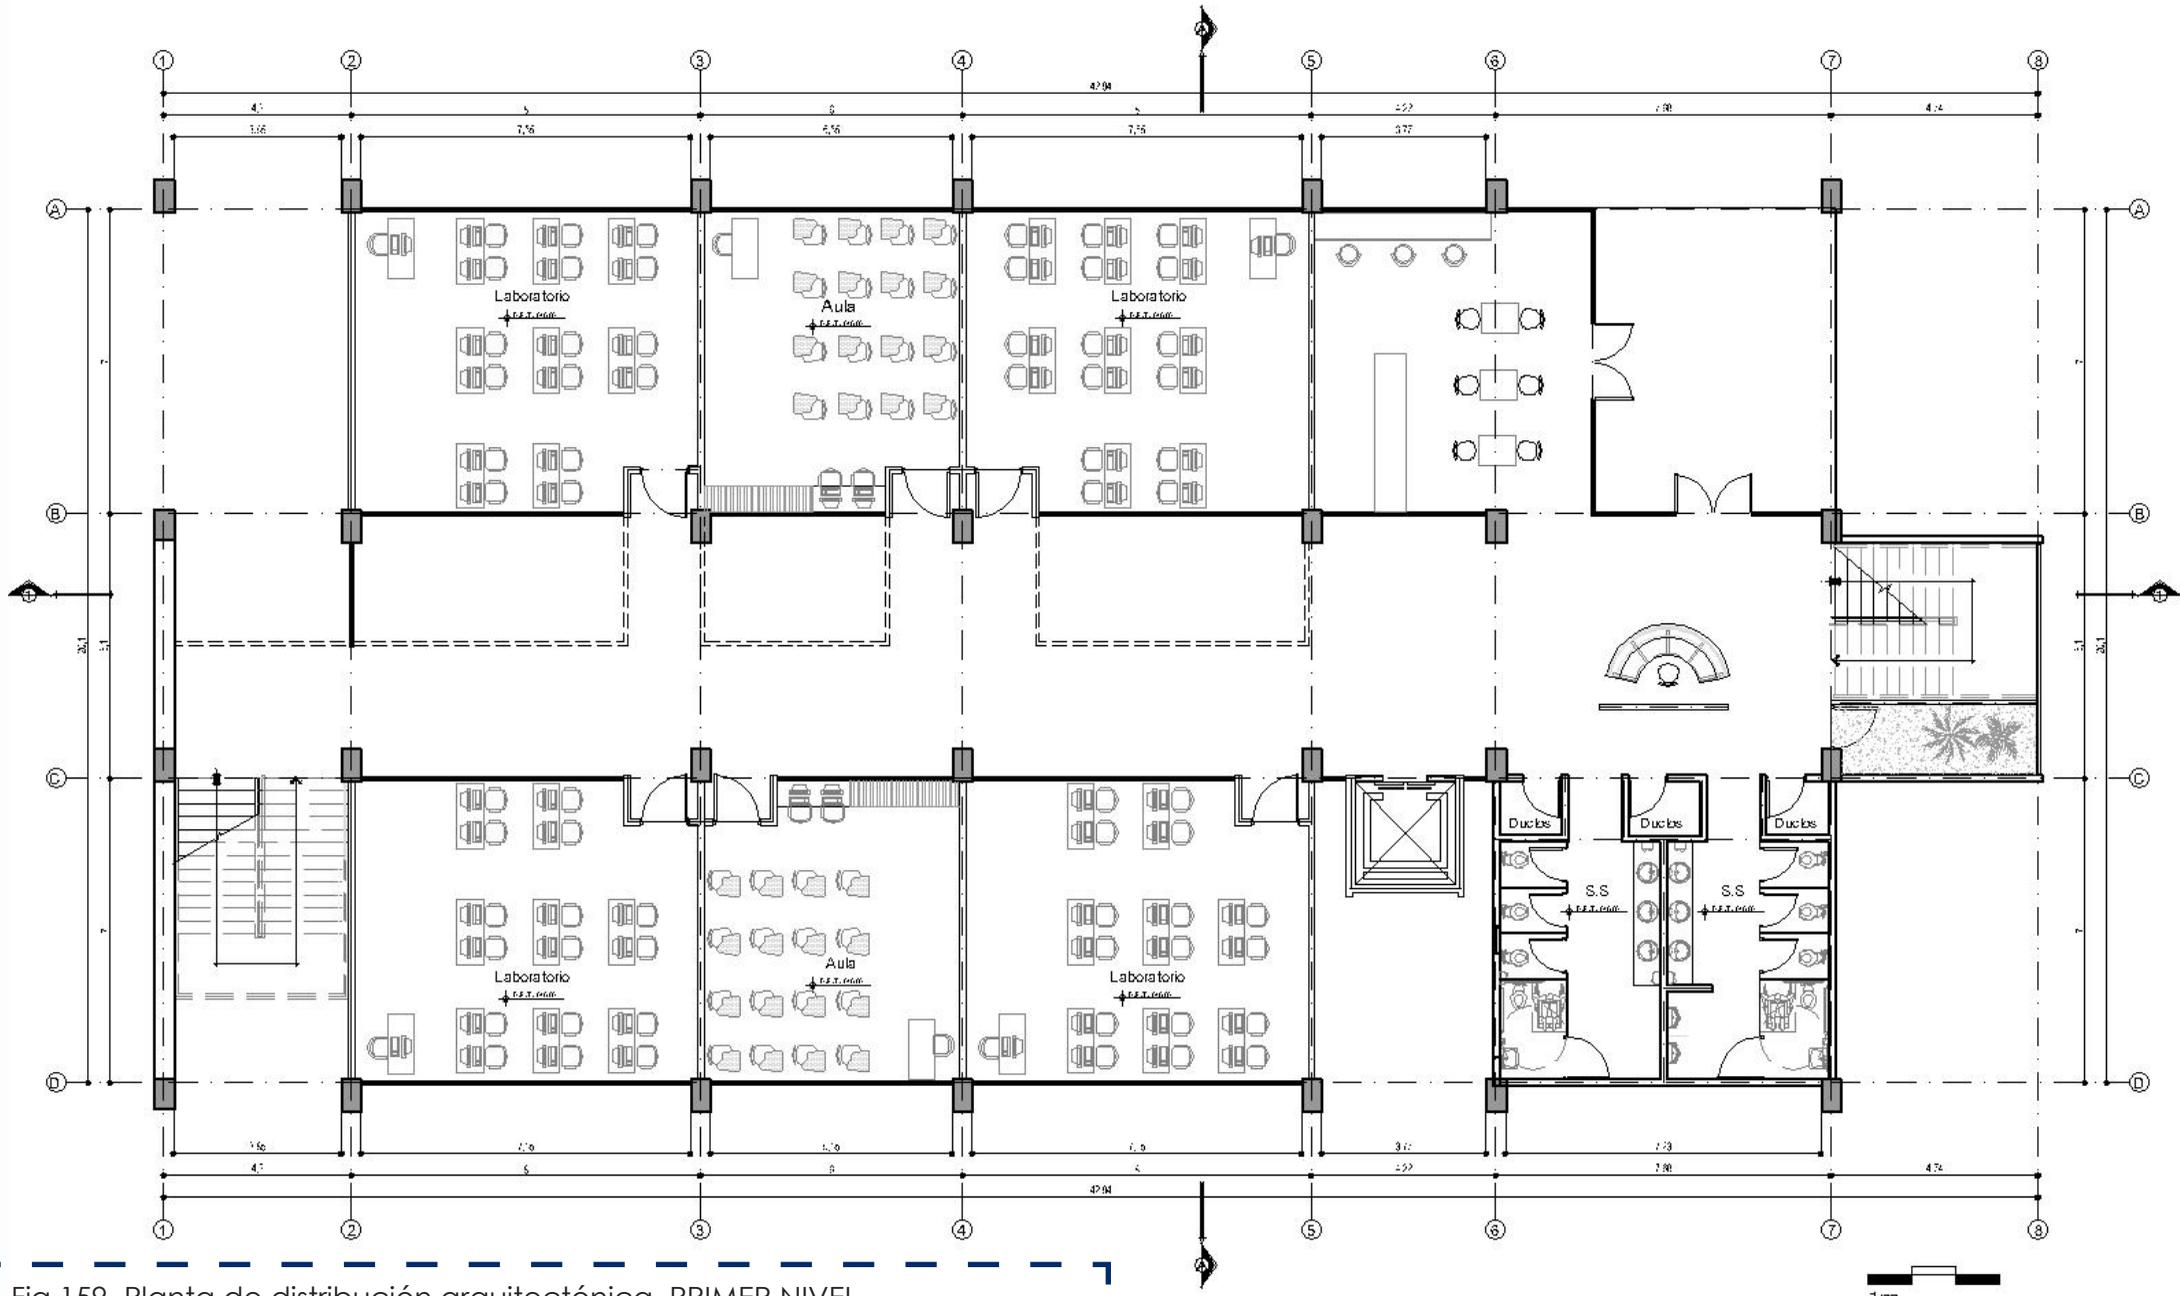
Planta de distribución arquitectónica. PRIMER NIVEL
